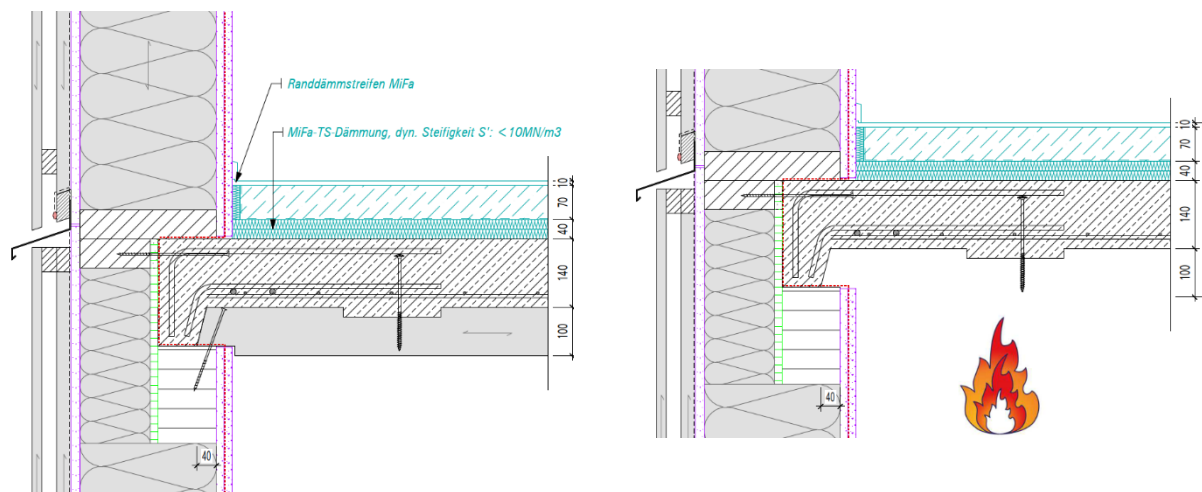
Alternatives Auflager einer HBV-Decke mit Auflagernocke, nach dem Abbrand der Holzschicht
